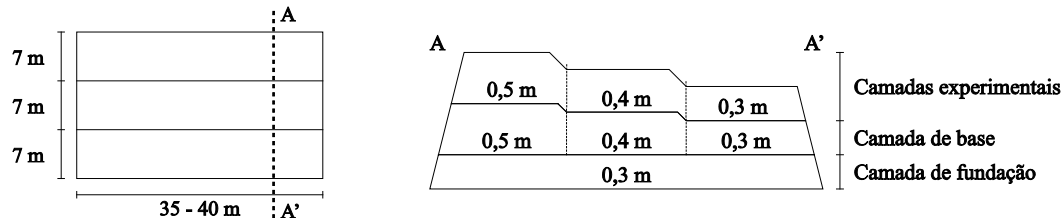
Vista das Camadas dos Aterros Experimentais (sem escala) em Planta (esquerda) e em Corte Transversal (direita)
